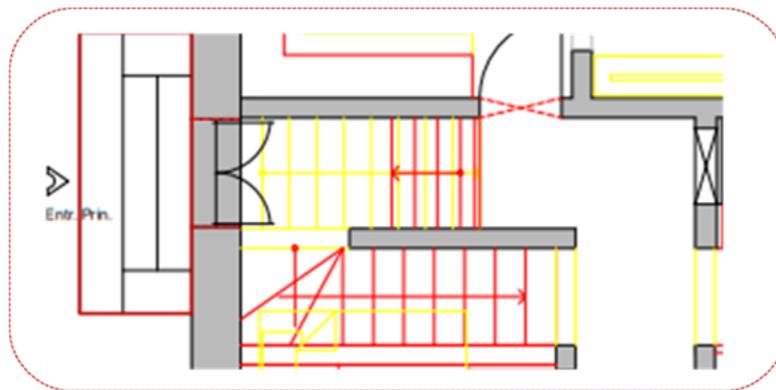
2 - Pormenor da planta na zona da entrada principal (vermelhos [a construir] e amarelos [a demolir], escada (Fonte: de autor).
